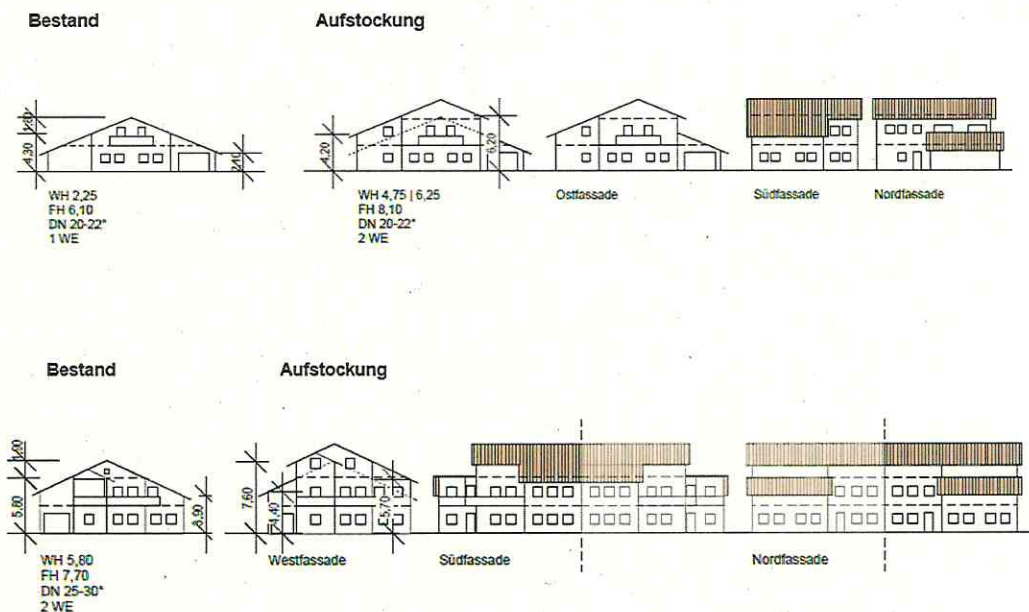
Untersuchung Höhenentwicklung, oben Einzelhaus, unten Doppelhaus, PV München, Stand Mai 2025
